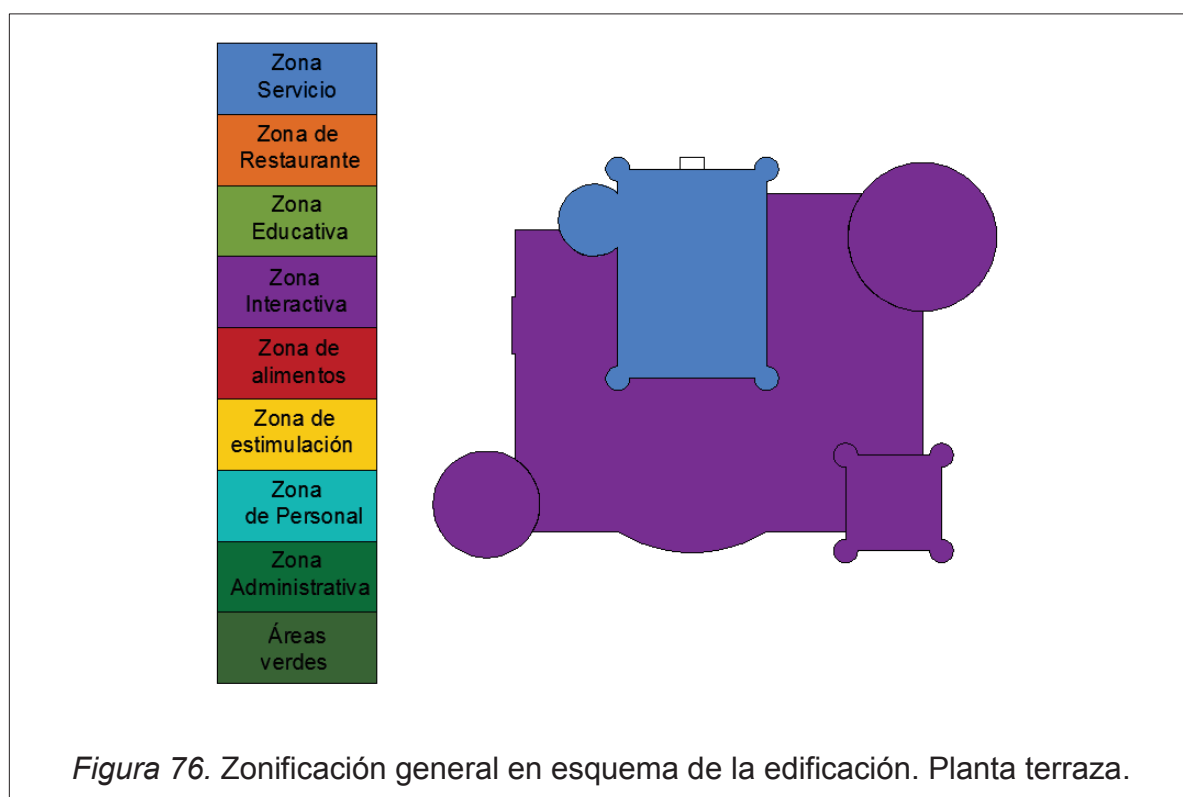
Zonificación general en esquema de la edificación. Planta terraza.
